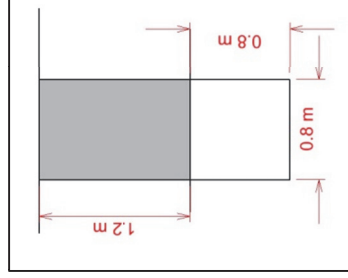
Estructura SC02, culvert del FFCC Bcn-Blanes sobre el rial de Sant Crist.
